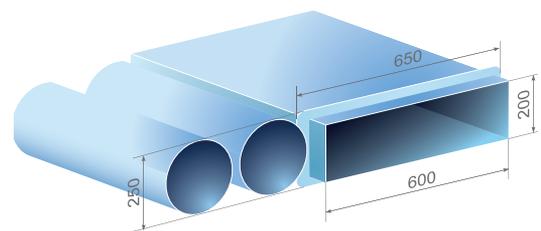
Без использования дополнительного пространства воздуховоды прямоугольного сечения часто могут заменяться несколькими воздуховодами круглого сечения.
